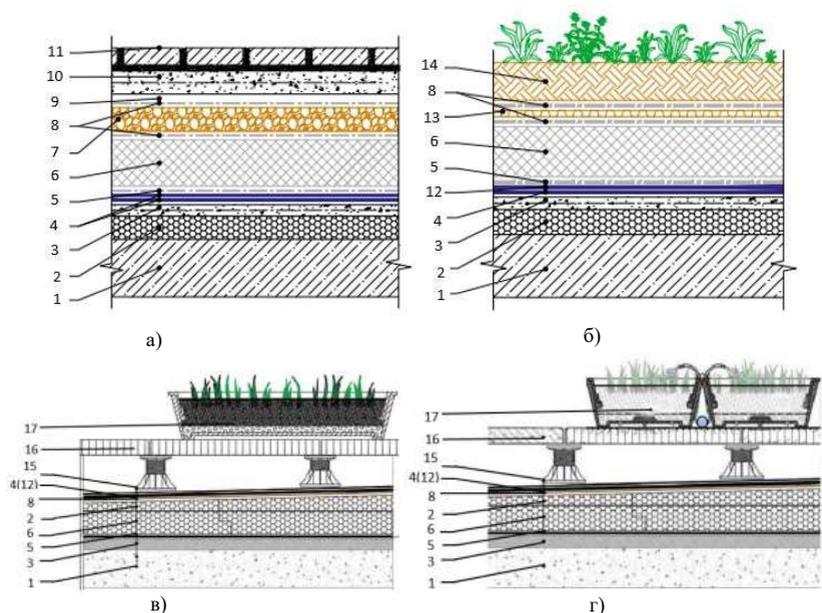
Конструктивно-технологические решения эксплуатируемых кровель: а) кровля под пешеходную нагрузку; б) кровля с системами сплошного озеленения; в) кровля с модульными системами озеленения (модули диаметром 1м); г) кровля с модульными системами озеленения (модули диаметром 0,5м).
